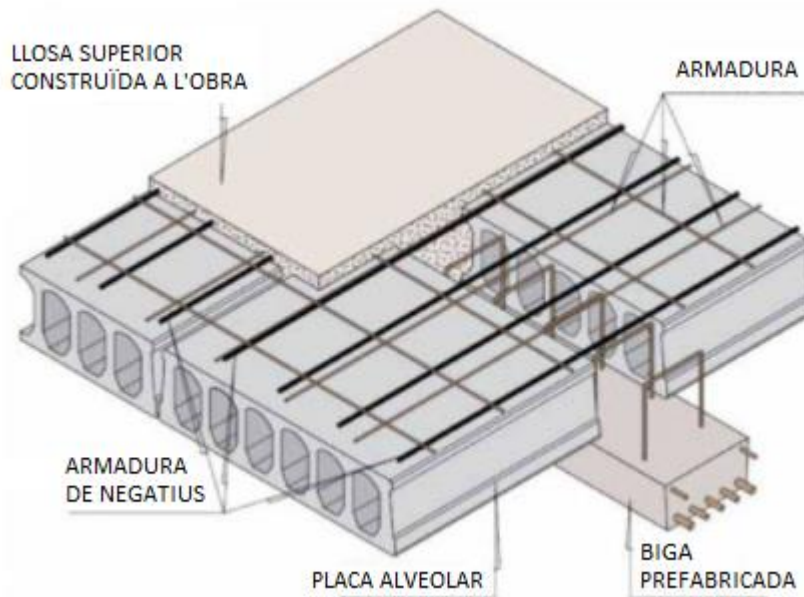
Components que formen un forjat de placa alveolar. (Font: "Prefabricados alve" [38])
